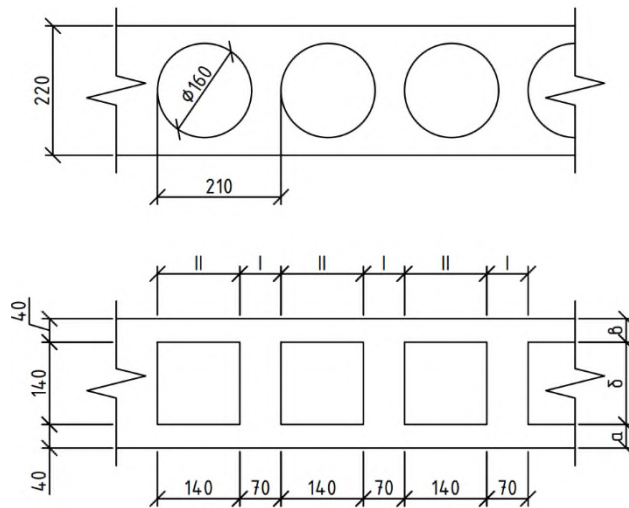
Поперечное сечение плиты и расчетная схема
